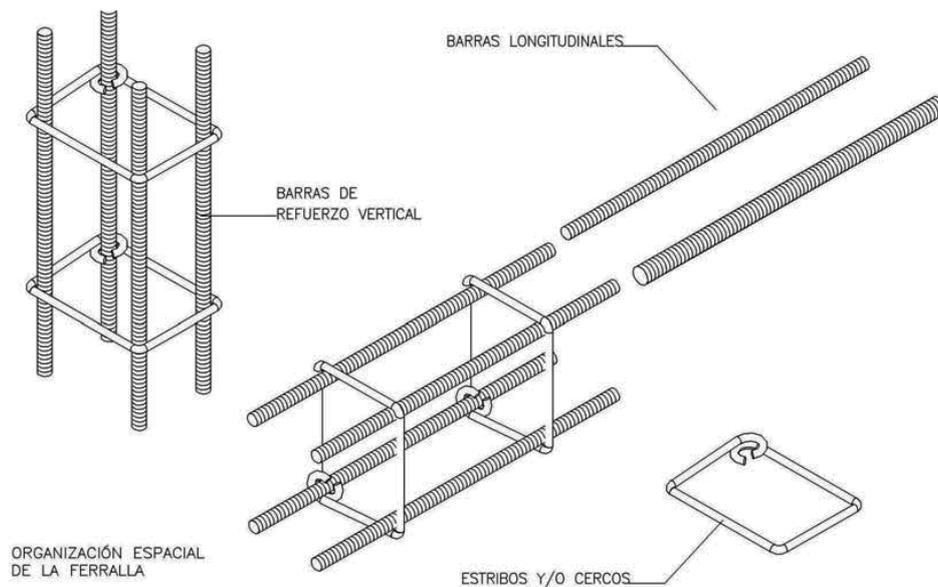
Barras, estribos y ferralla espacial de pilares y vigas o zunchos.
